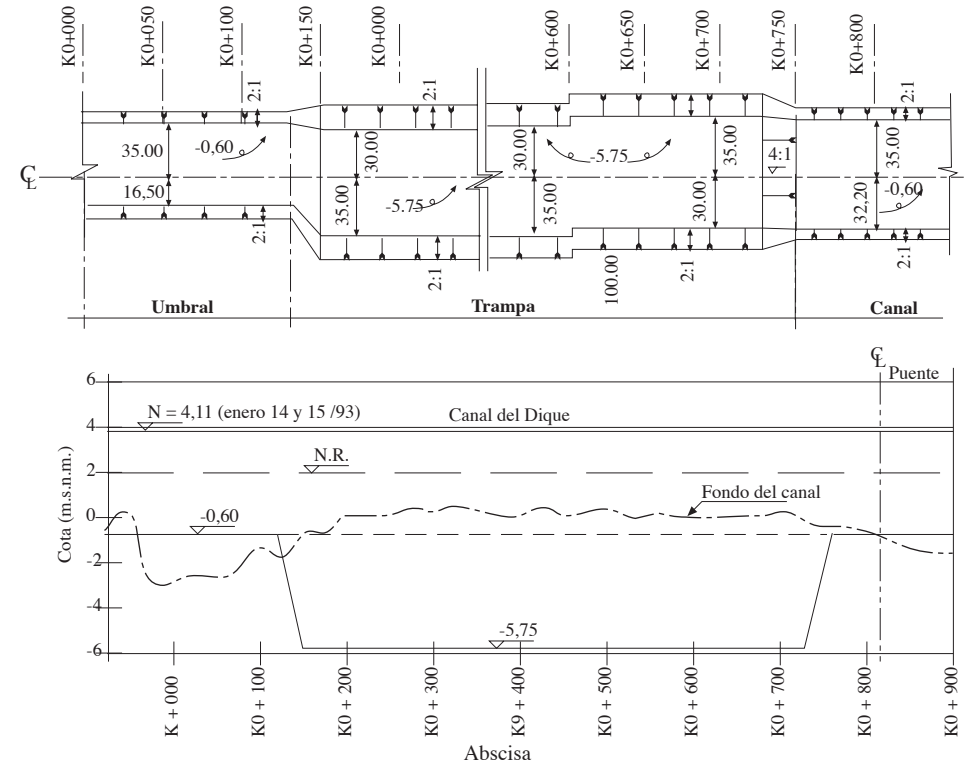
Planta (arriba) y perfil de la trampa de Calamar
